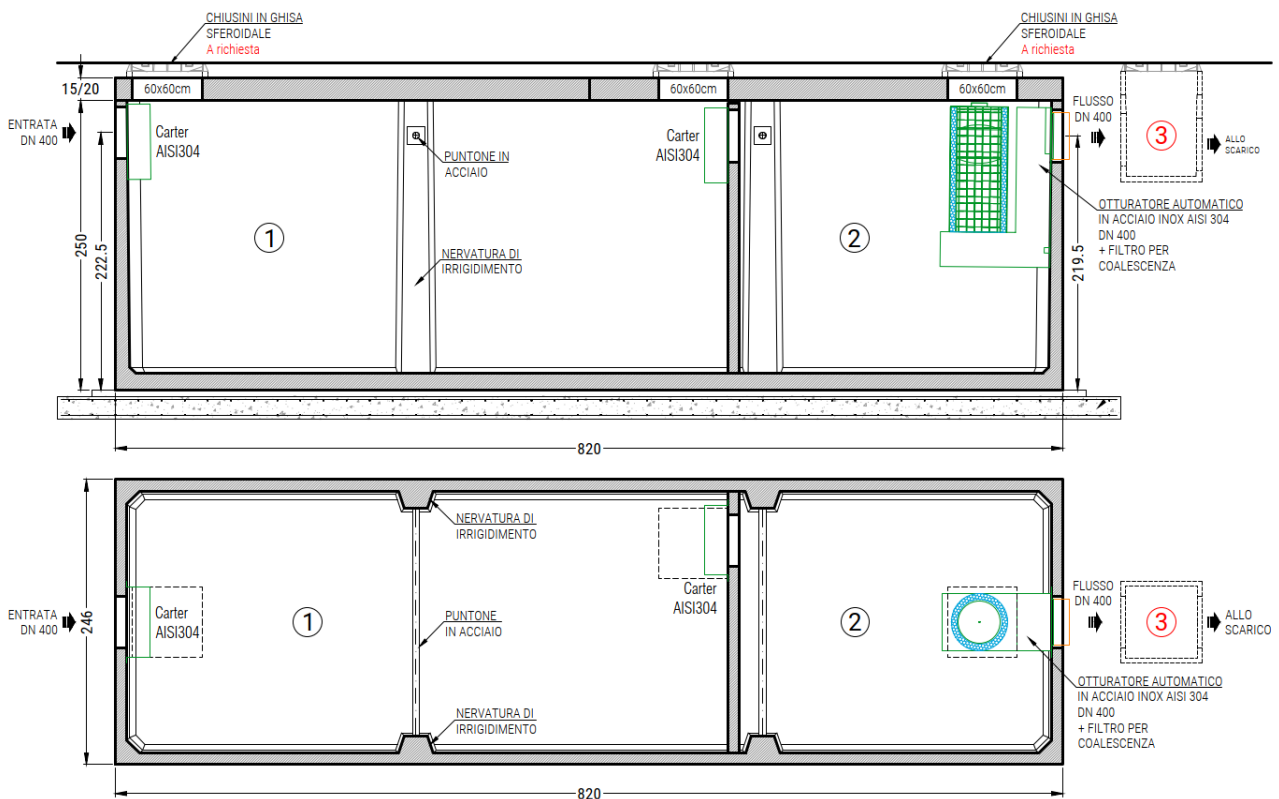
Sezione e pianta della vasca di prima pioggia.
